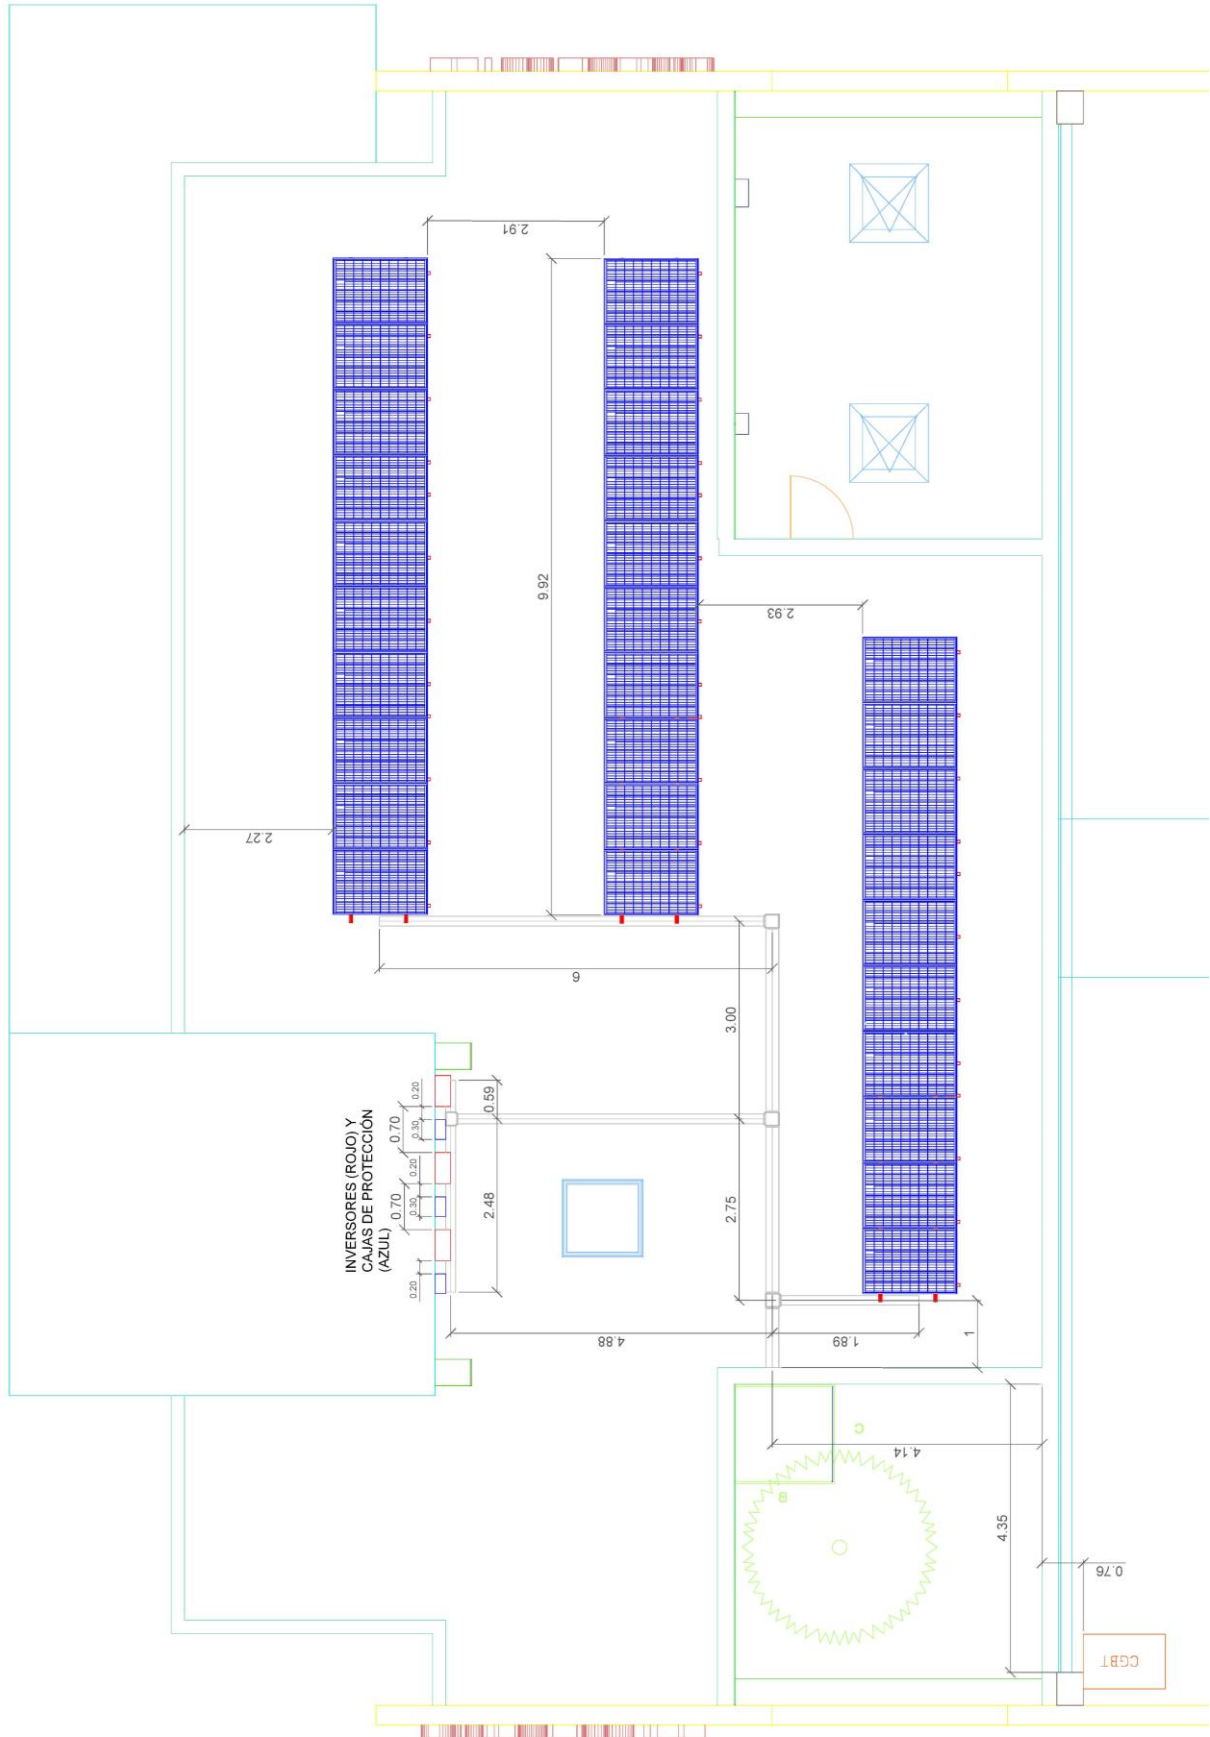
Vista en planta de la cubierta, con la instalación fotovoltaica al completo.
